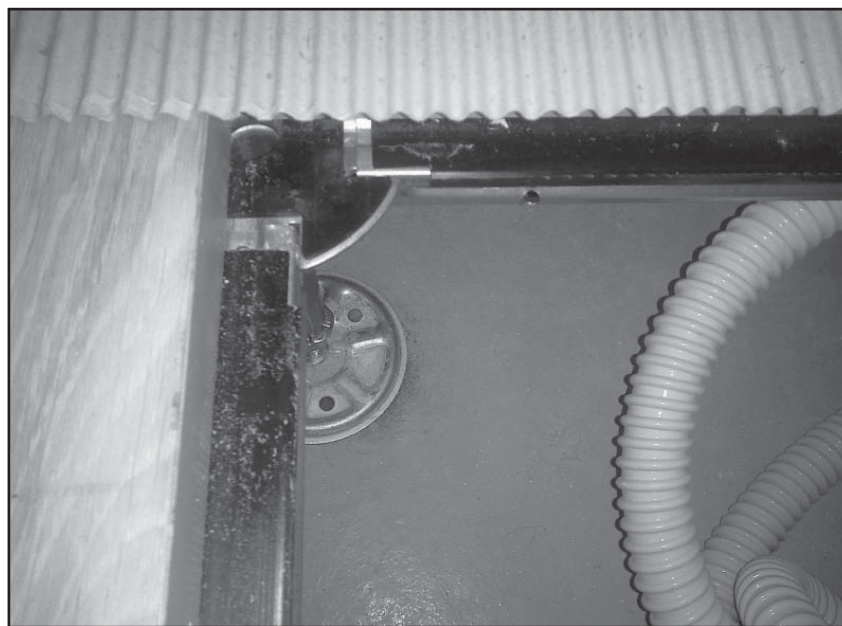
Dettaglio del pavimento sopraelevato con “funghi” direttamente appoggiati sulla soletta
